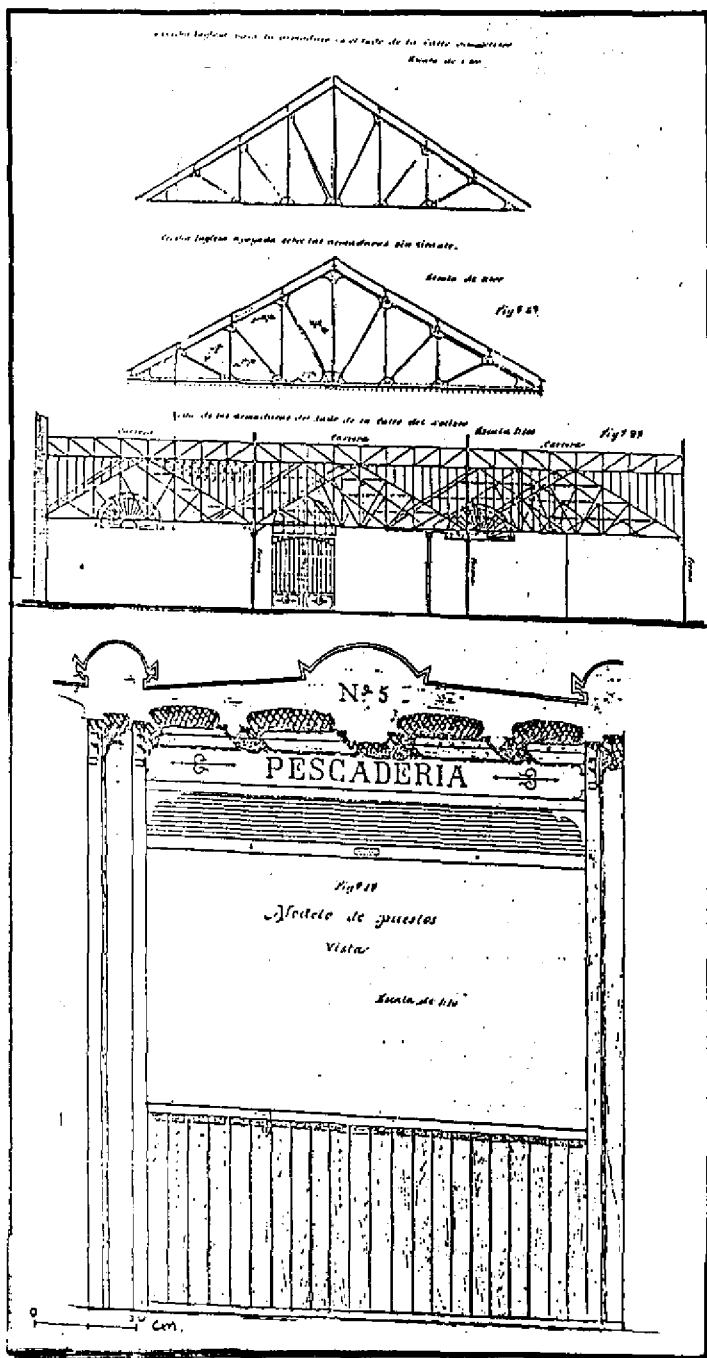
Detalles del proyecto de 1907. (A.M.T.).
